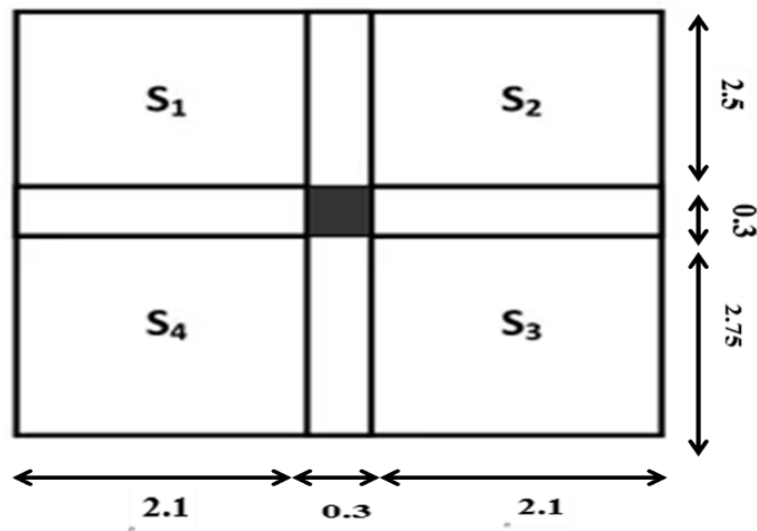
La surface afférente sur poteau intermédiaire (B3)
